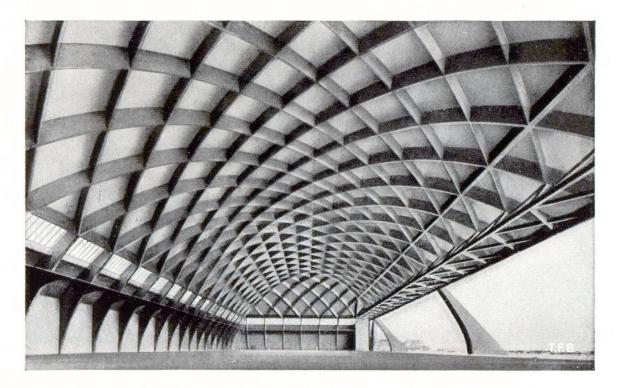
Hangar en béton armé pour avions. (102×40) construit par Pier Luigi Nervi
